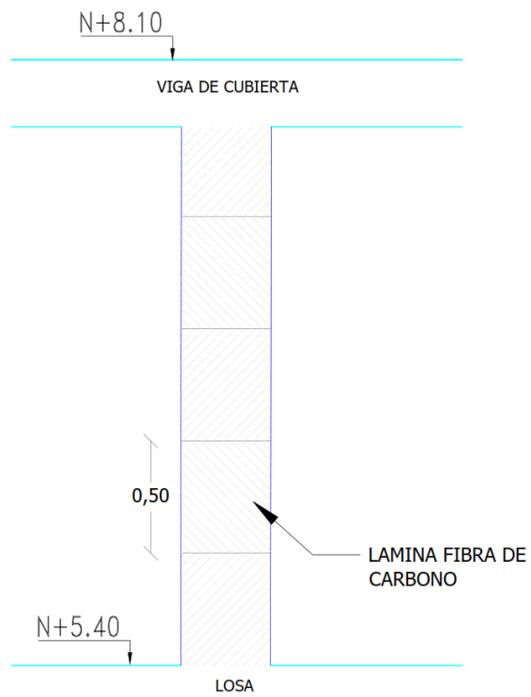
Detalle de reforzamiento con fibra de Carbono.
